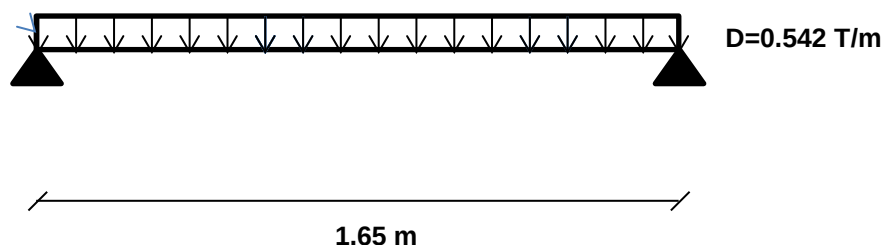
Esquema simplificado de la losa entre vigas, para carga muerta, vista transversal.
